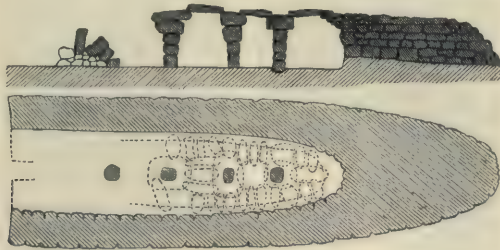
a u. b. Grab (»Naveta«) bei Son-Mercé auf Menorca. Längsschnitt u. Grundriss.
